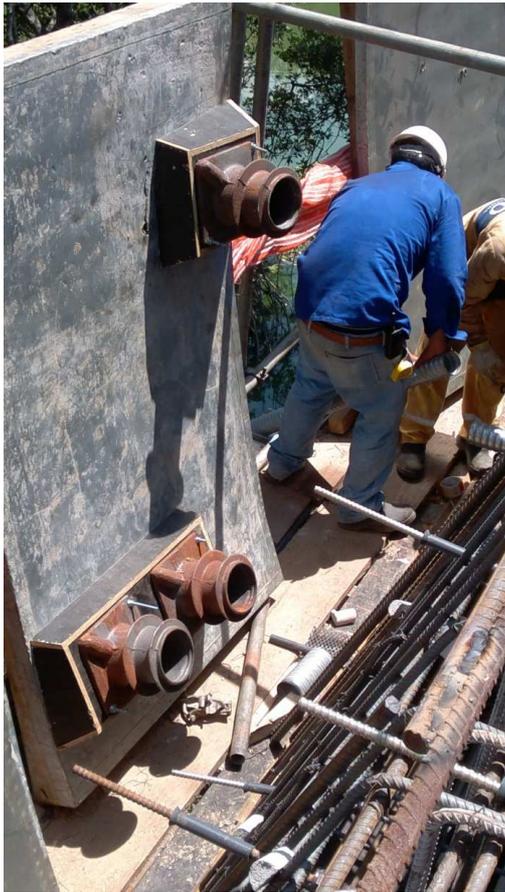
Cassero con ancoraggi dei cavi trasversali / Deck lateral formwork with transversal cable anchorages
